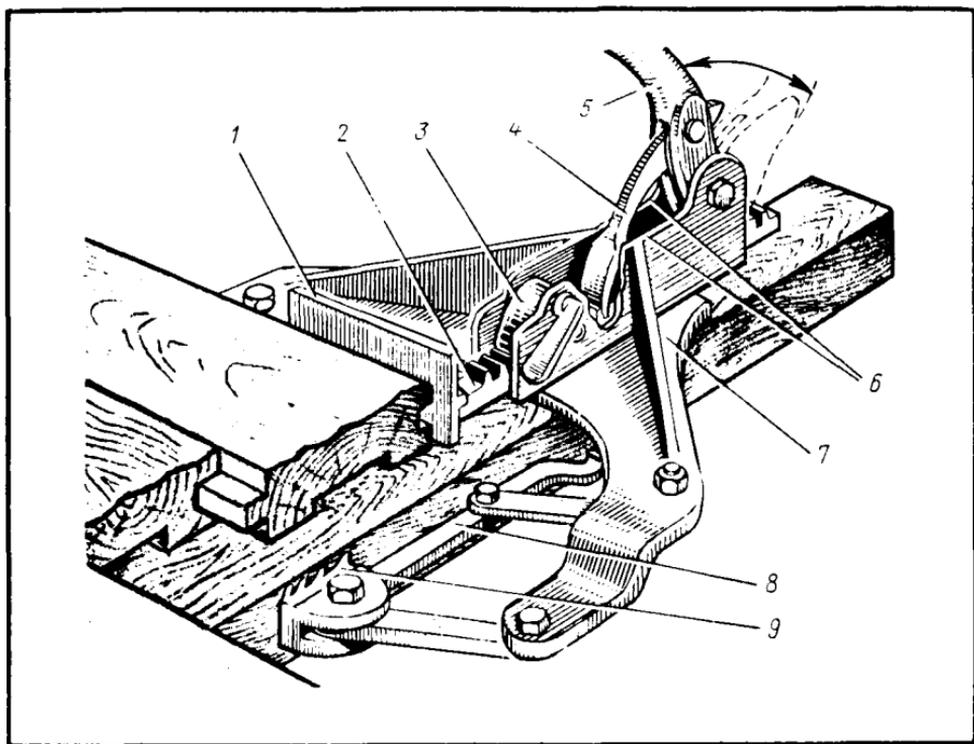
Сжим для сплачивания досок пола: 1 — упорная планка, 2 — зубчатая рейка, 3 — стопорная собачка, 4 — стопор, 5 — рычаг, 6 — щеки, 7 — рама, 8 — тяга, 9 — захват
